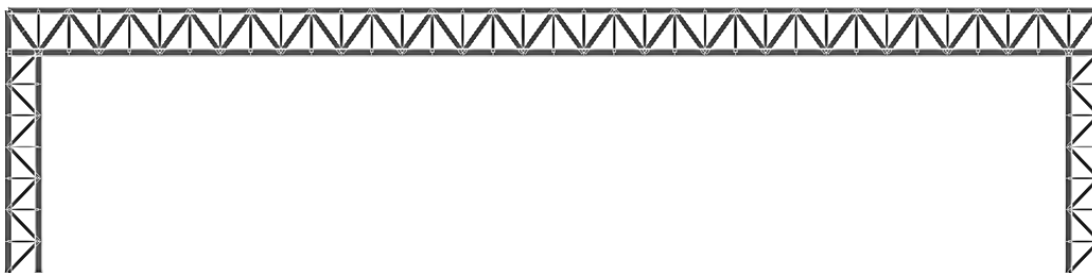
Загальний вигляд поздовжньої рами
